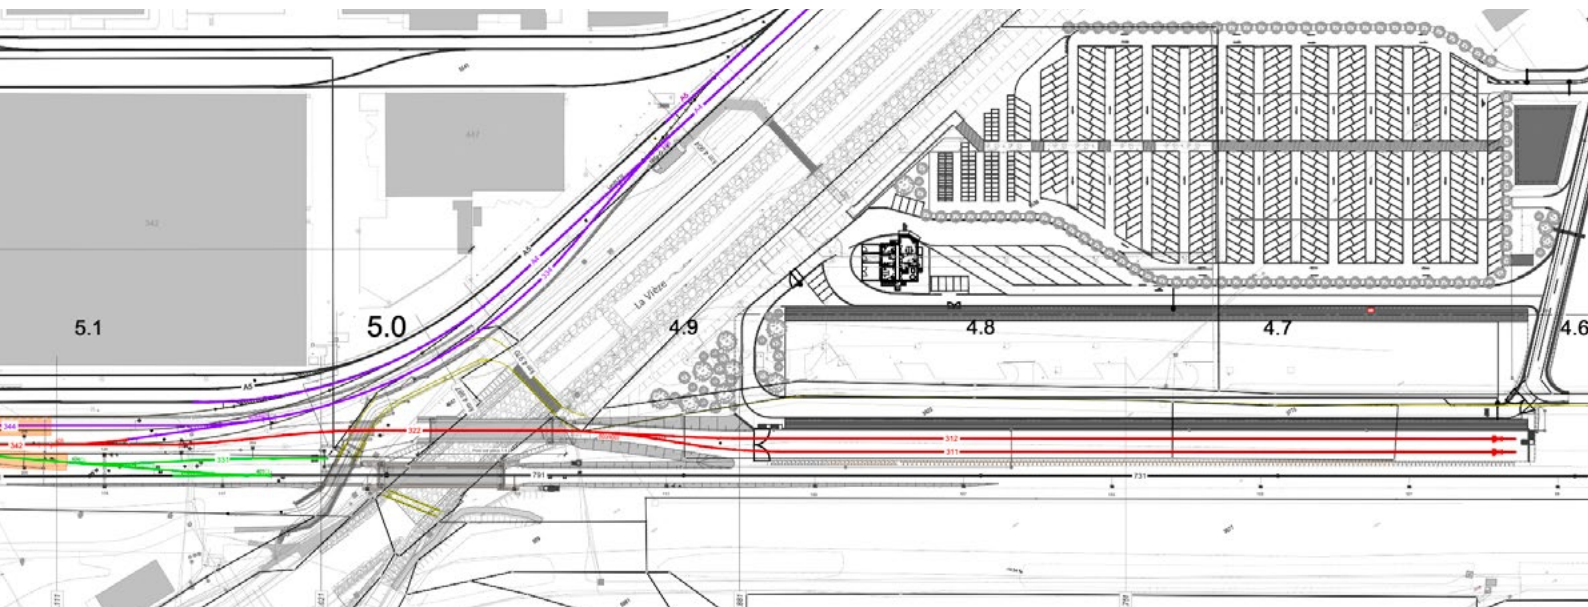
plan des infrastructures ferroviaires du terminal (rouge) et de la nouvelle entrée du site chimique (violet)
